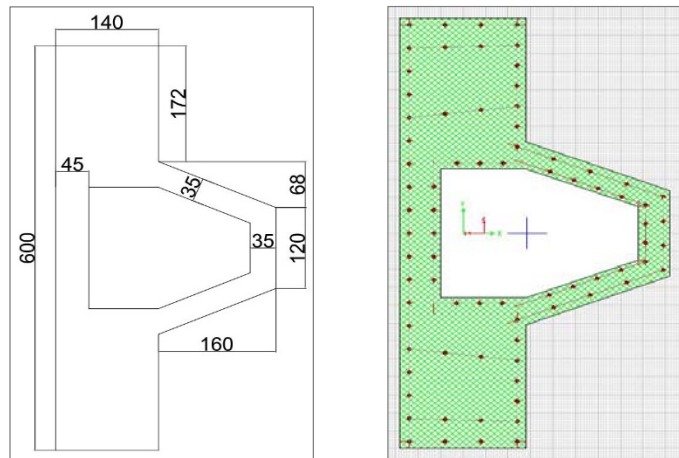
Dimensiones y distribución de refuerzo de la sección inferior de las piernas de la torre en el tramo atirantado.
